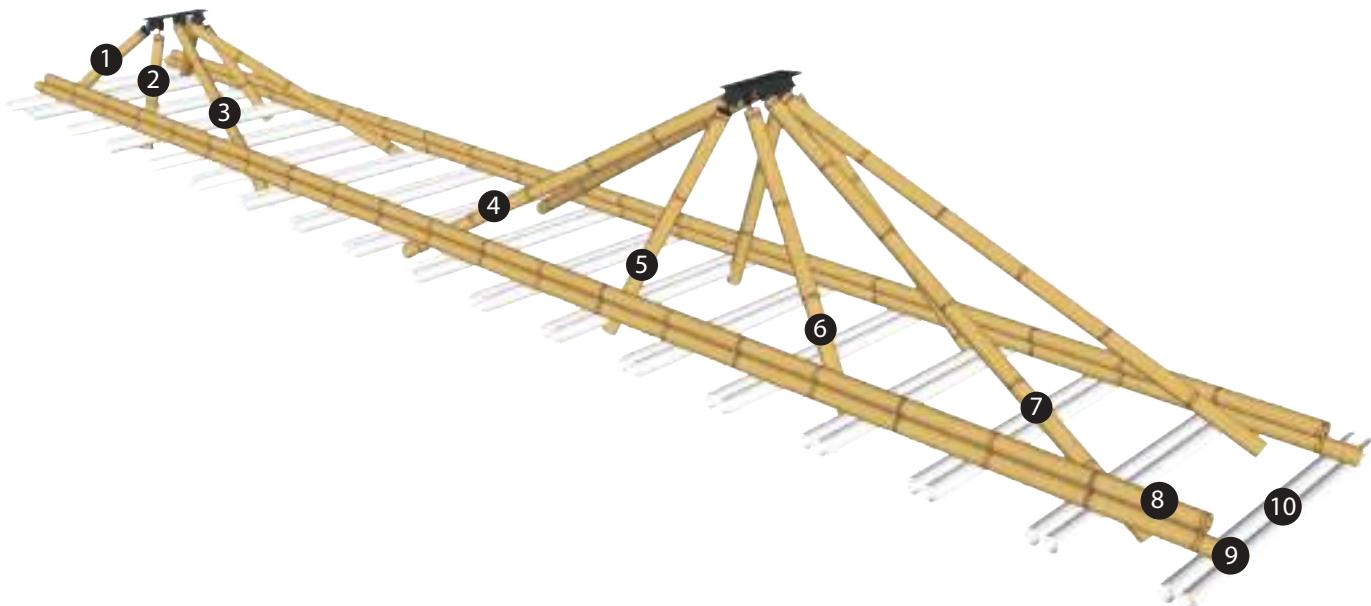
Estructura de armadura hecha en el suelo vista en perspectiva.
